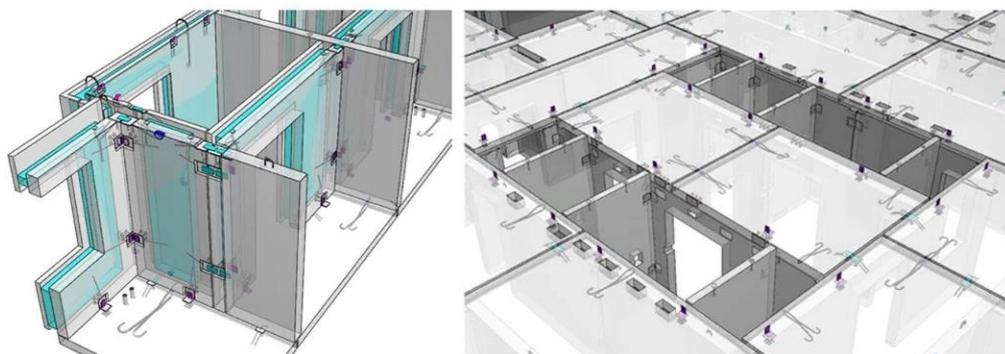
Стыки стеновых панелей и плит перекрытий
